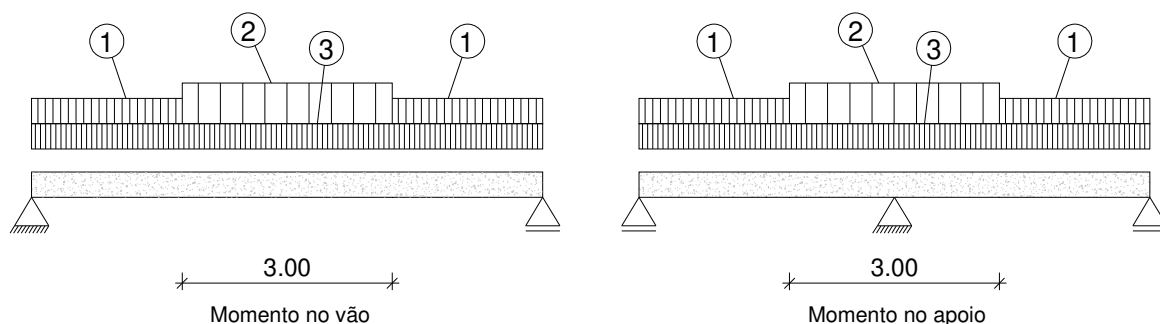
Sobrecargas de construção para chapas perfiladas utilizadas como cofragem
